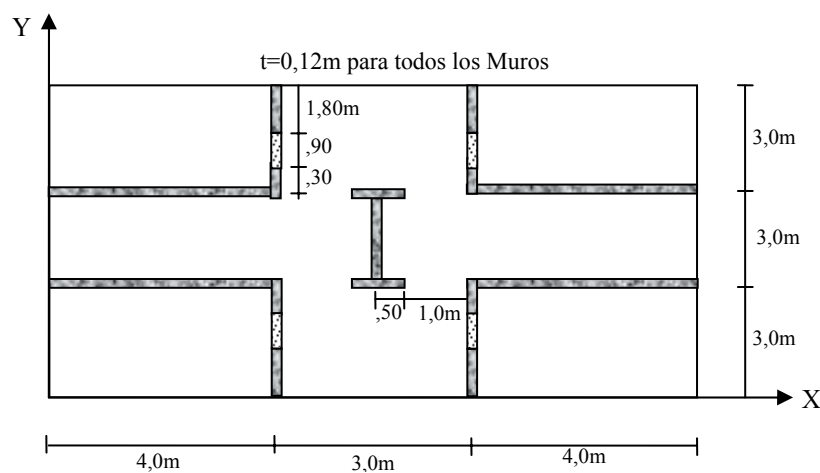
(a) Geometría en planta; ejemplo 2.
